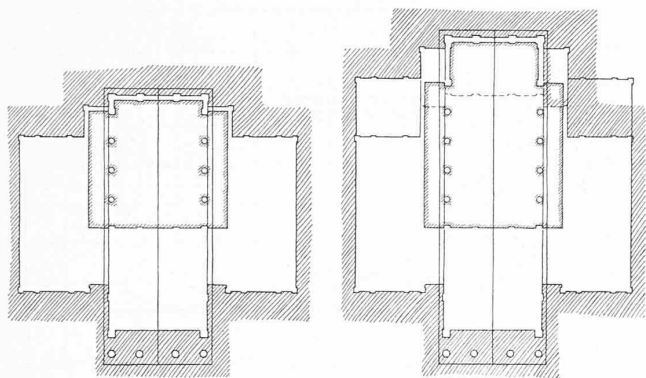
Grundrisse 1 : 1000, links bestehend, rechts umgebaut.
